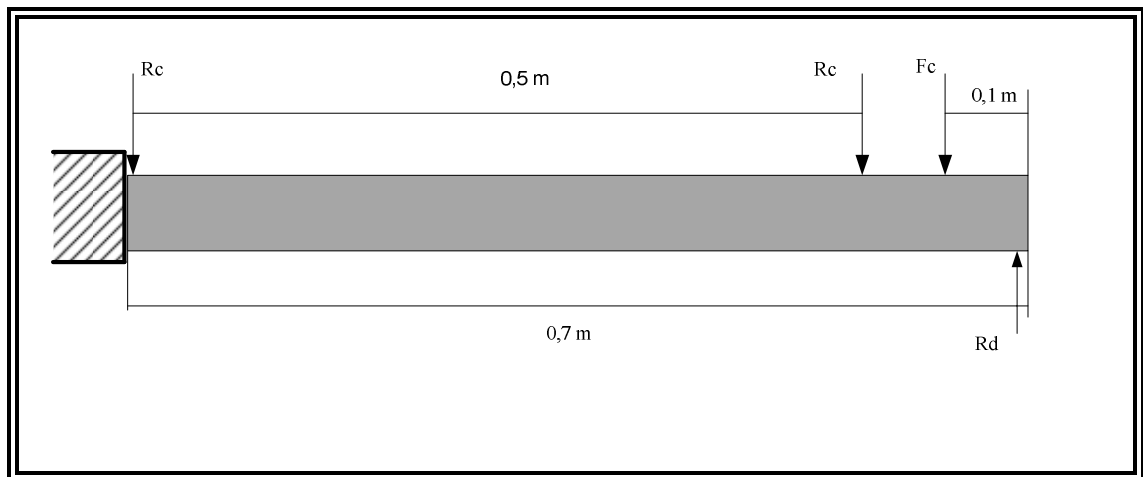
Detalle de viga. Fuente: Elaboración propia.
